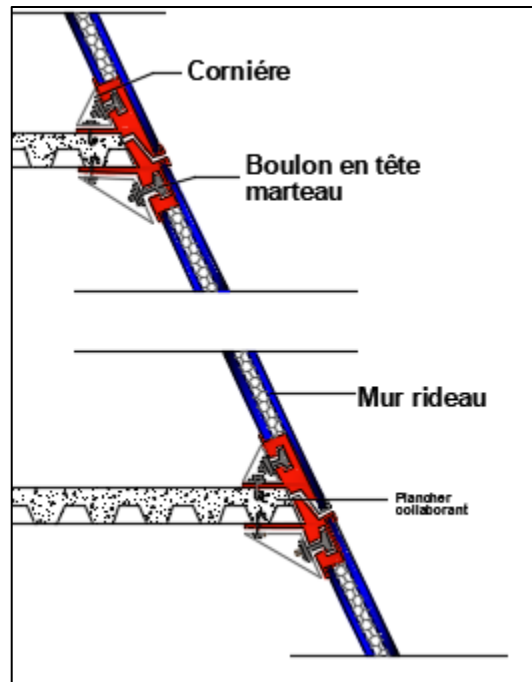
détail de fixation de mur rideau sur une façade inclinée Source Google image
